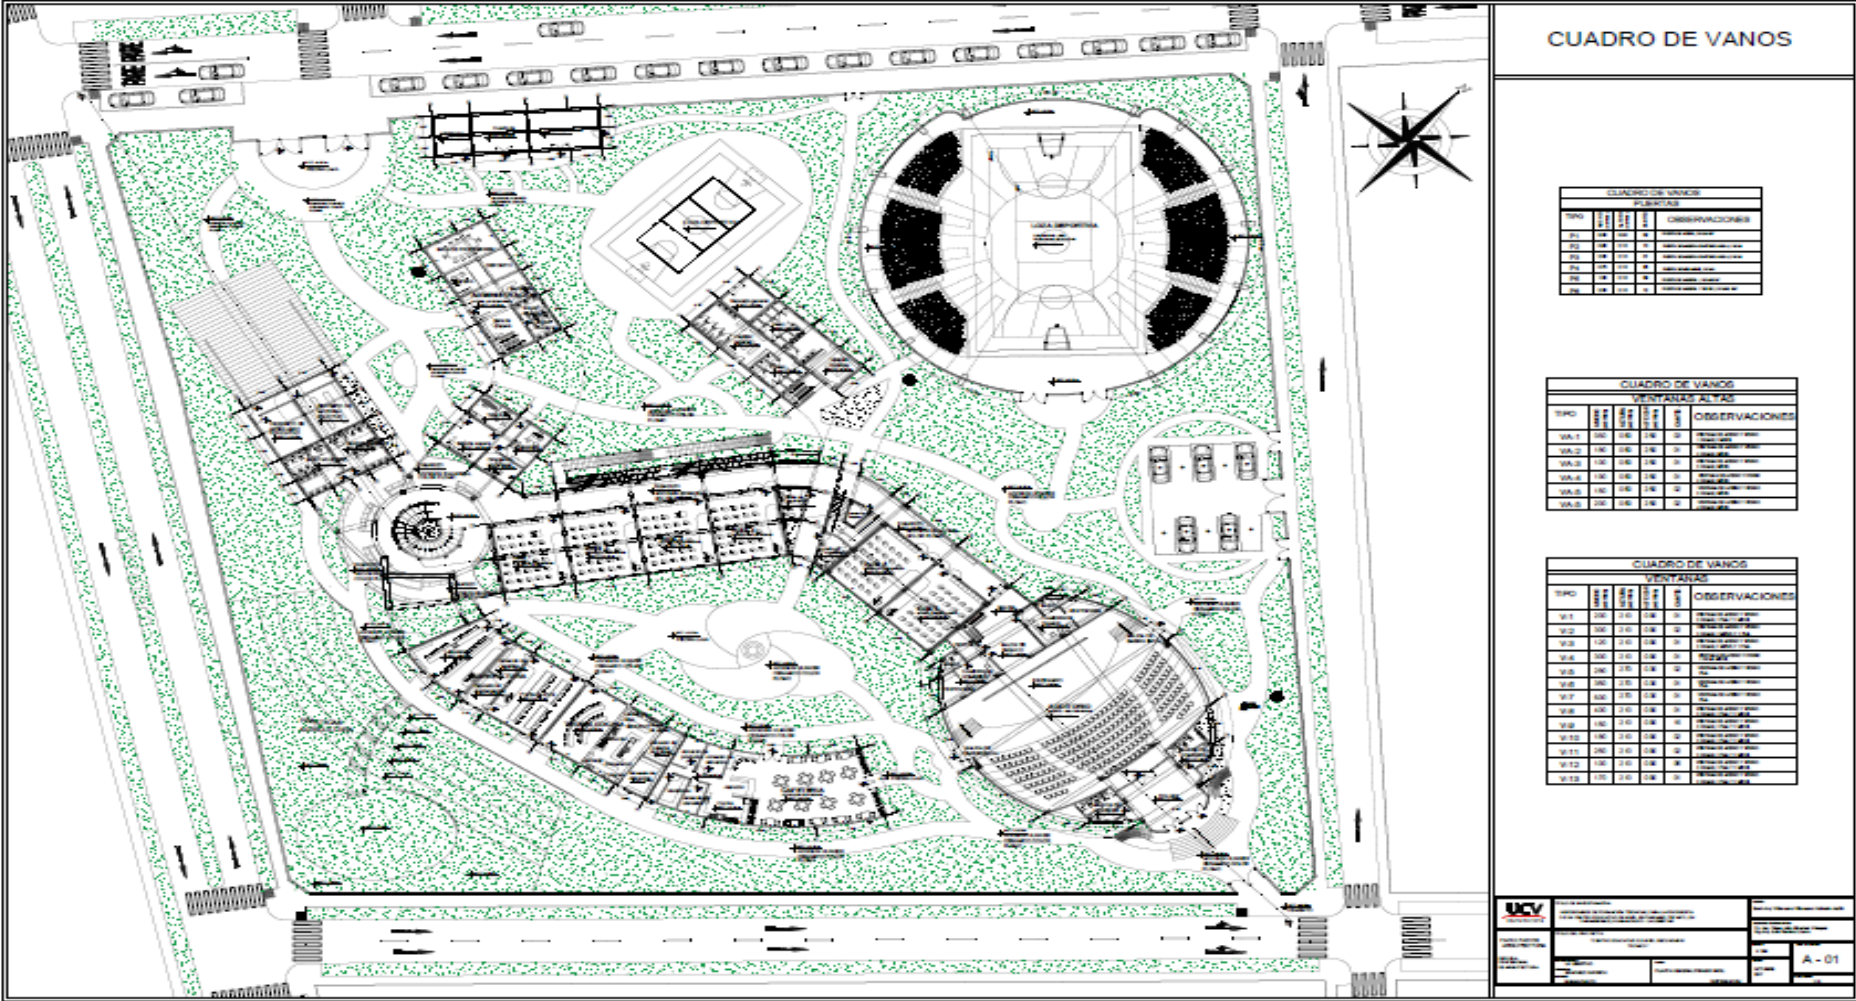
Plano de Distribución – Plano N° 05 - Lamina A-01
